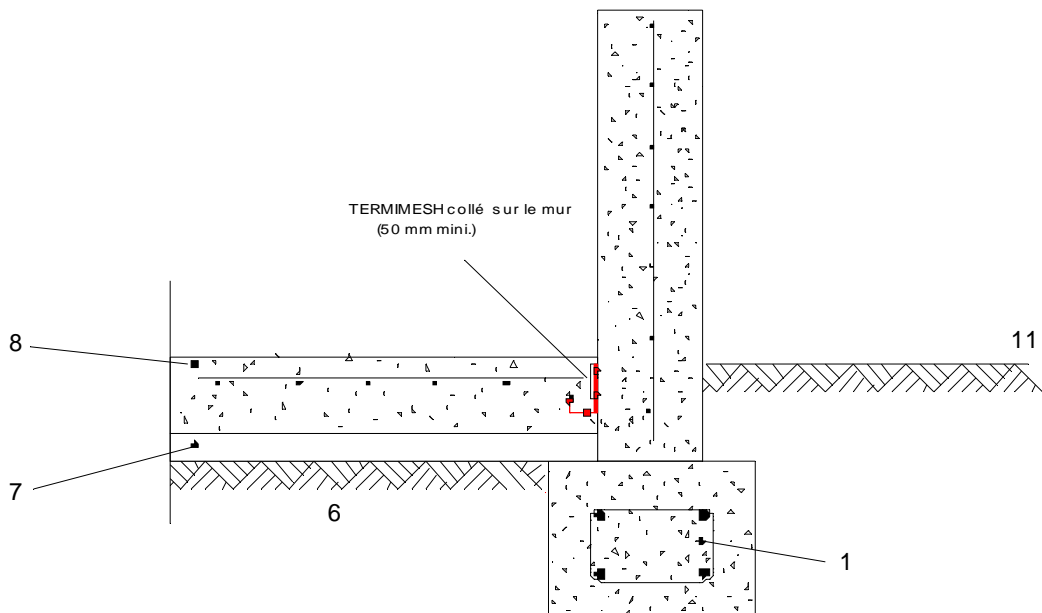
EU 1.3-1 : dallage désolidarisé et mur banché, pose avant coulage
